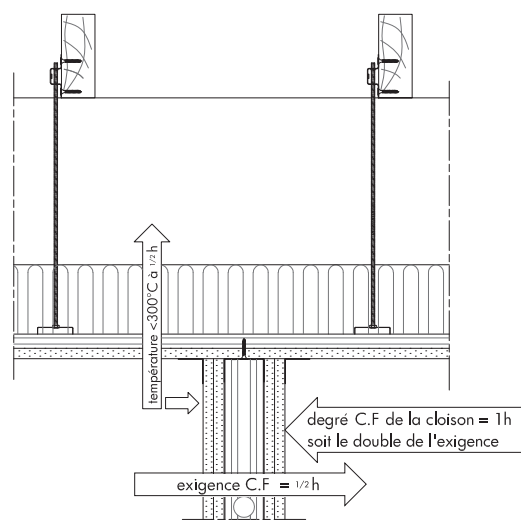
Cloisons fixées sous plafond - ERP type U
